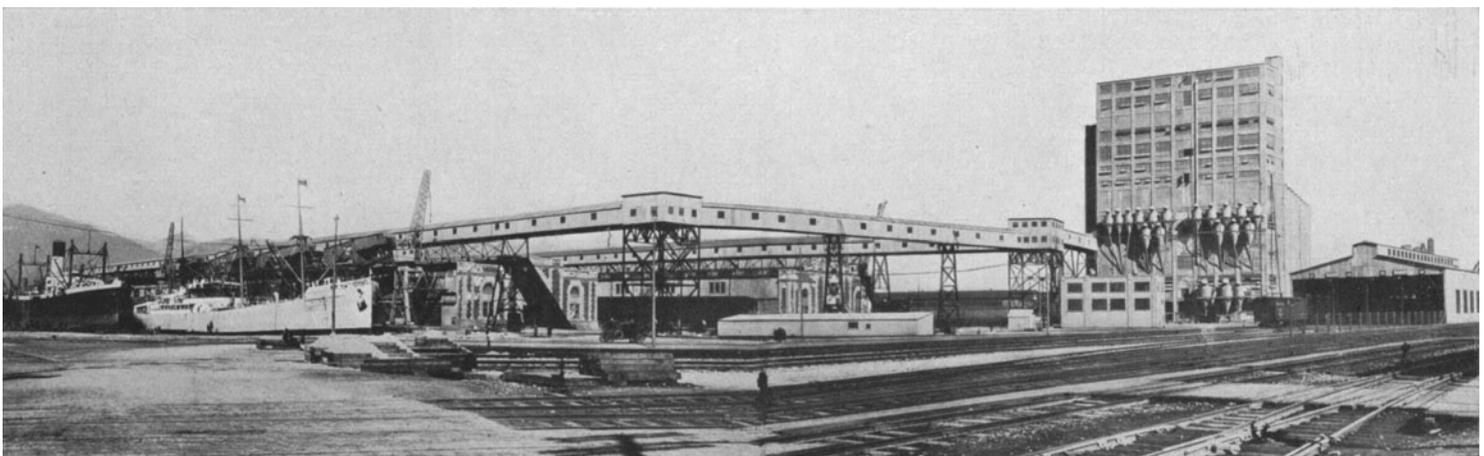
Aufnahme des Ballantyne-Piers aus Richtung Südwest nach Nordost (s. Plan Fig. 125) mit Verteilerkanälen, Elevator und Empfangsbahnhof.
